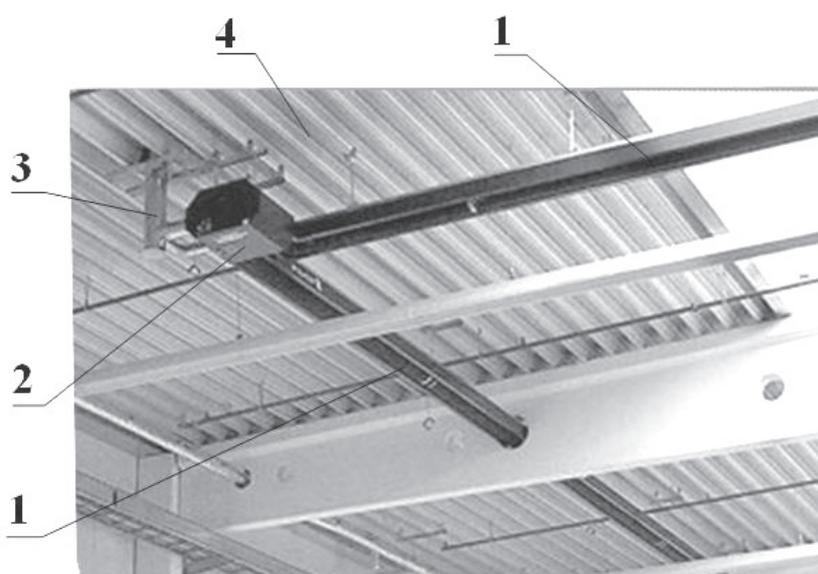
Общий вид ленточного инфракрасного обогревателя MAXITEMP (вид снизу):
